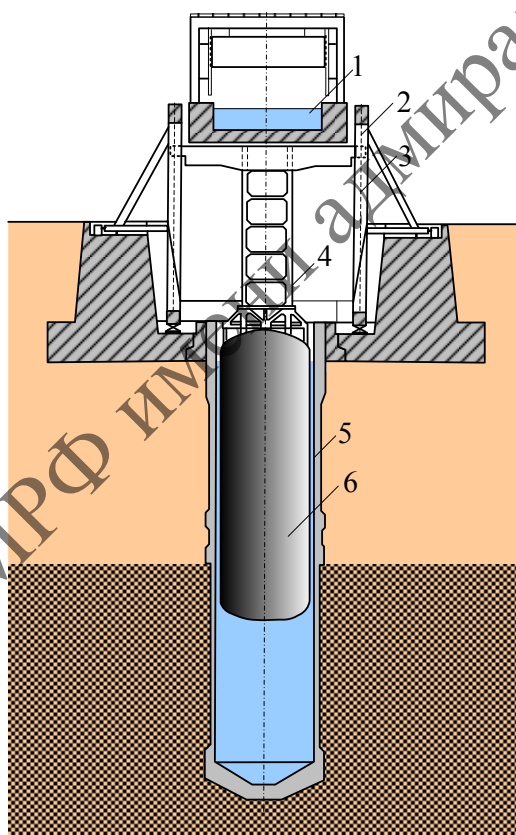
Поплавковый судоподъемник (Ротензее): 1 — подвижная приемная камера; 2 — направляющие конструкции; 3 — ходовой винт; 4 — конструкция, поддерживающая камеру; 5 — шахта; 6 — поплавок
